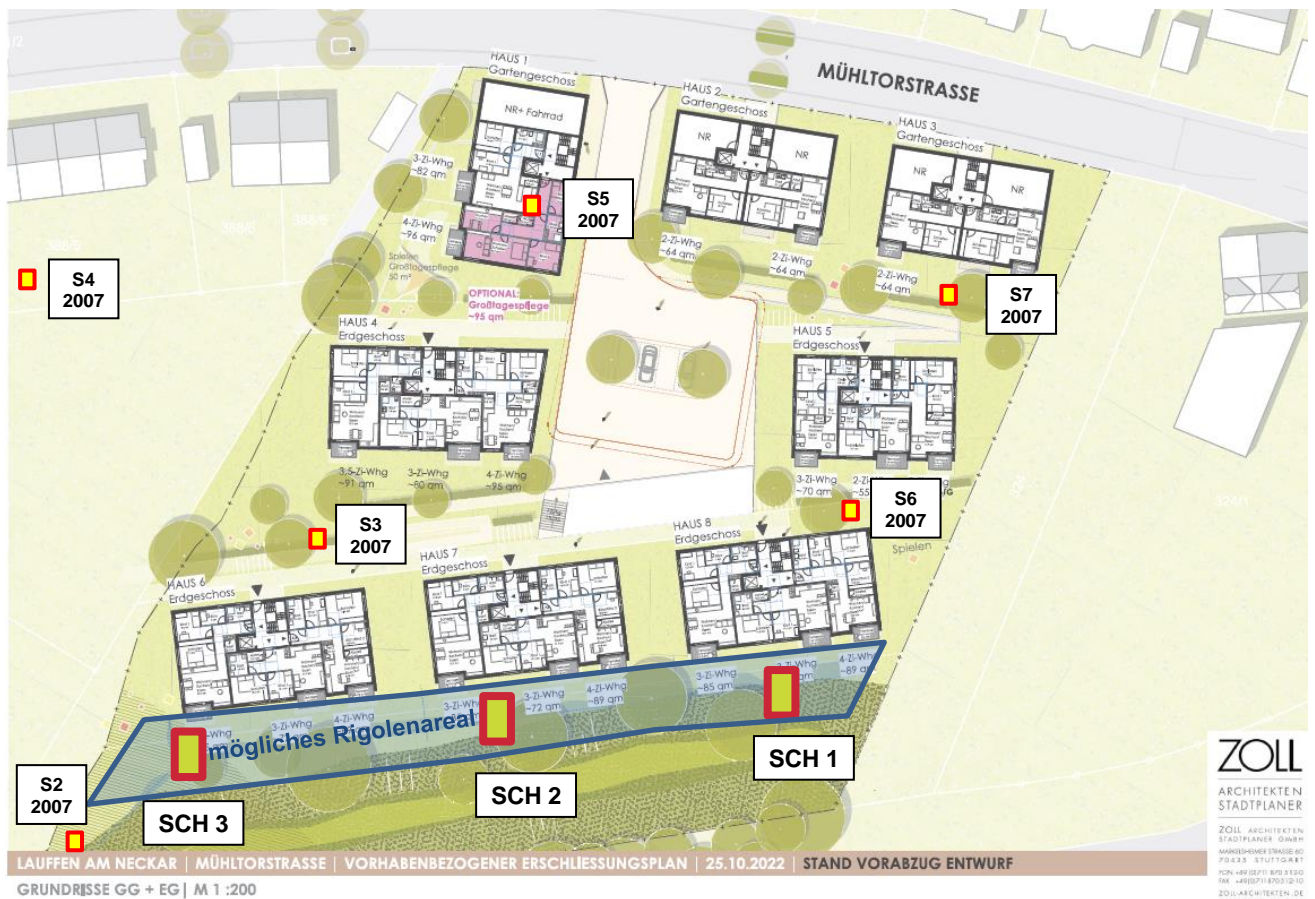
Grundriss Gartengeschoß mit Lage der Aufschlüsse
